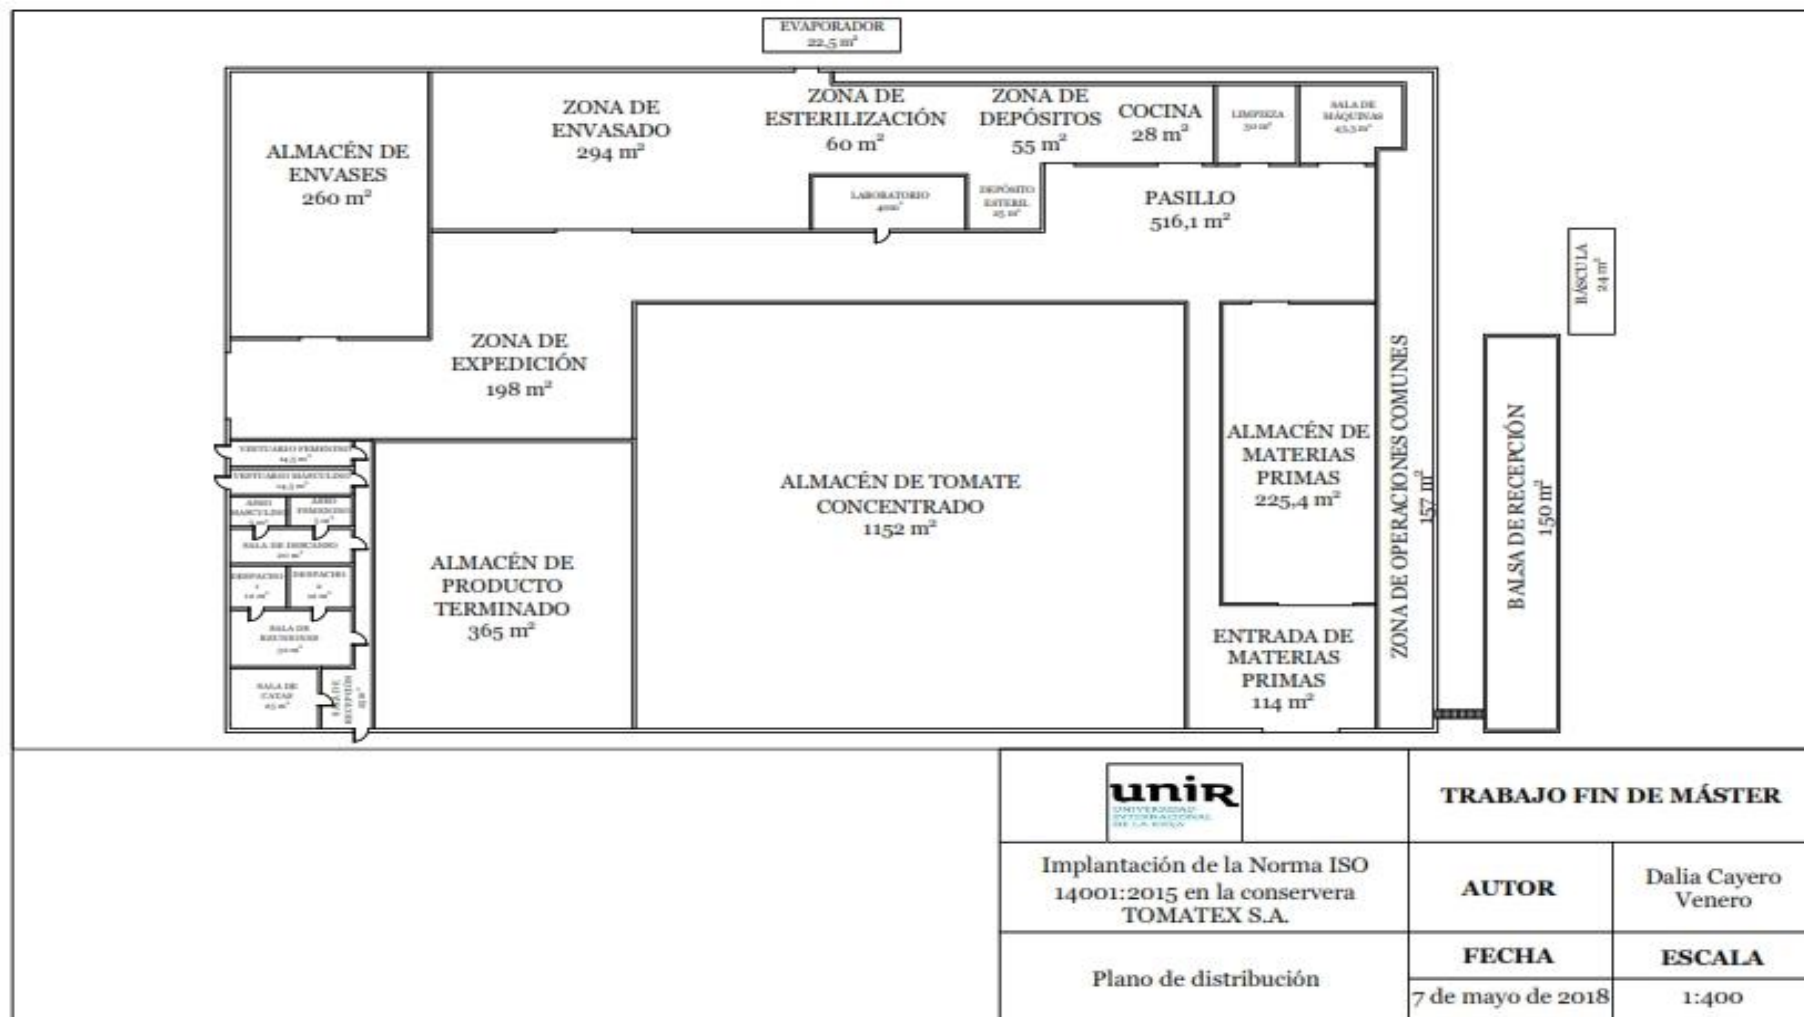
Plano de distribución de la planta (Elaboración propia a partir de Loitegui,2015)
